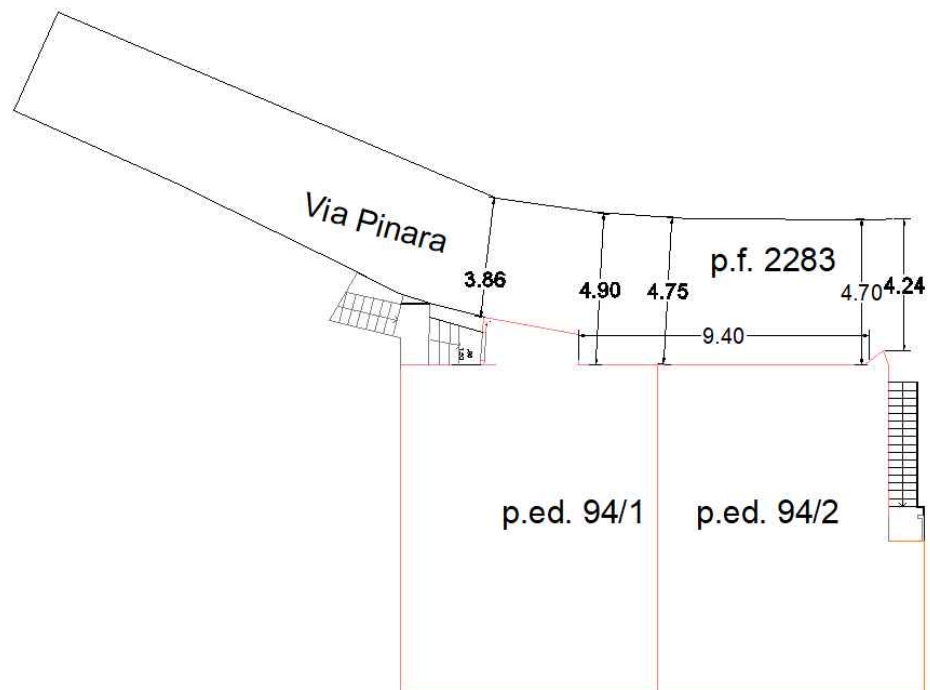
rilievo della larghezza di via Pinara nei pressi degli edifici interessati dall'intervento
